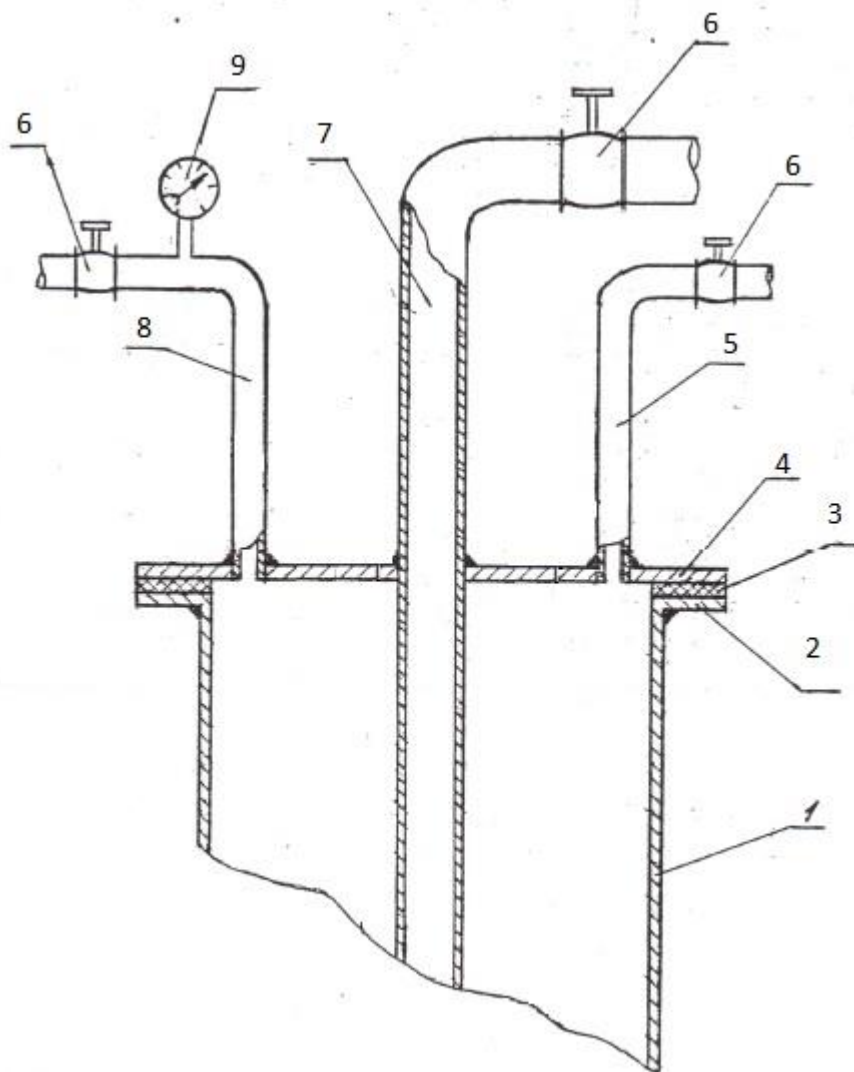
1-обсадная колонна, 2-нижний фланец, 3-уплотнительная прокладка, 4-крышка оголовка, 5-воздухопровод, 6-вентили, 7-реагентопровод, 8-трубопровод для сброса давления, 9-манометр.
